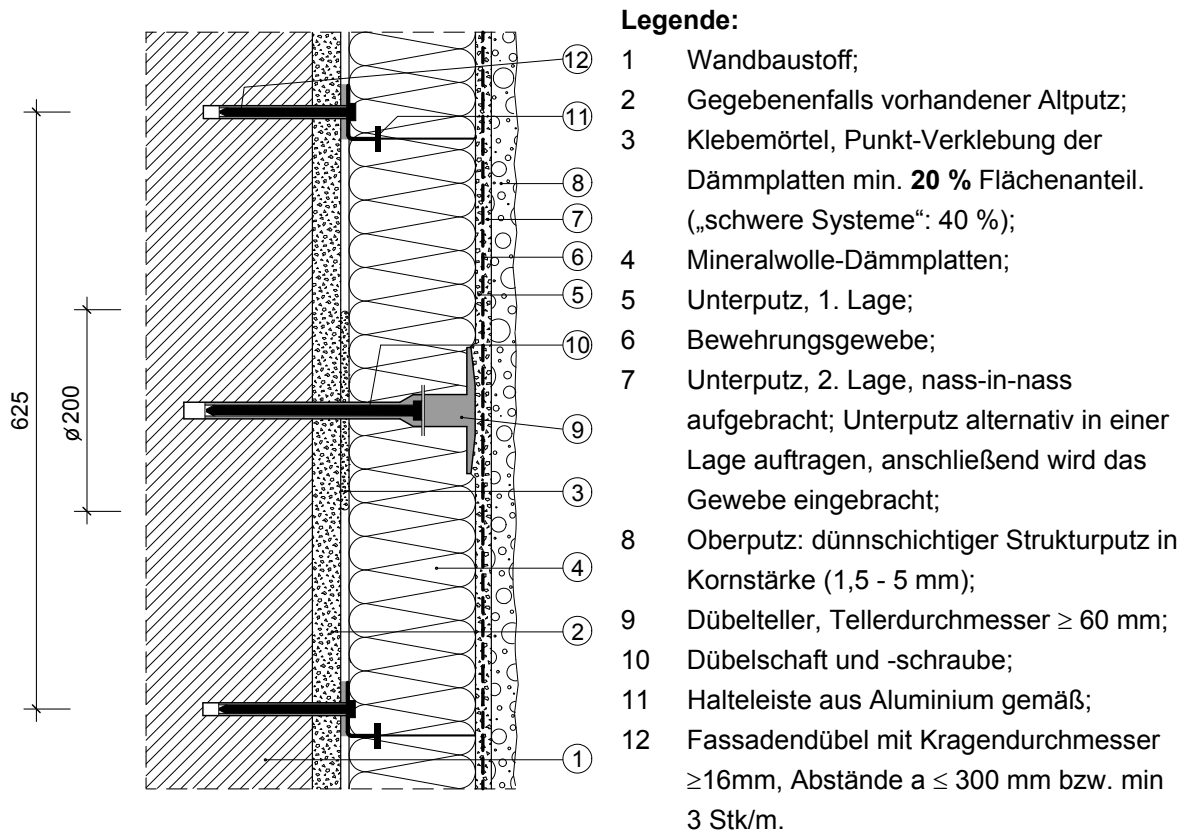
Aufbau eines WDV-S mit Halteleistenbefestigung (Maße in mm)
